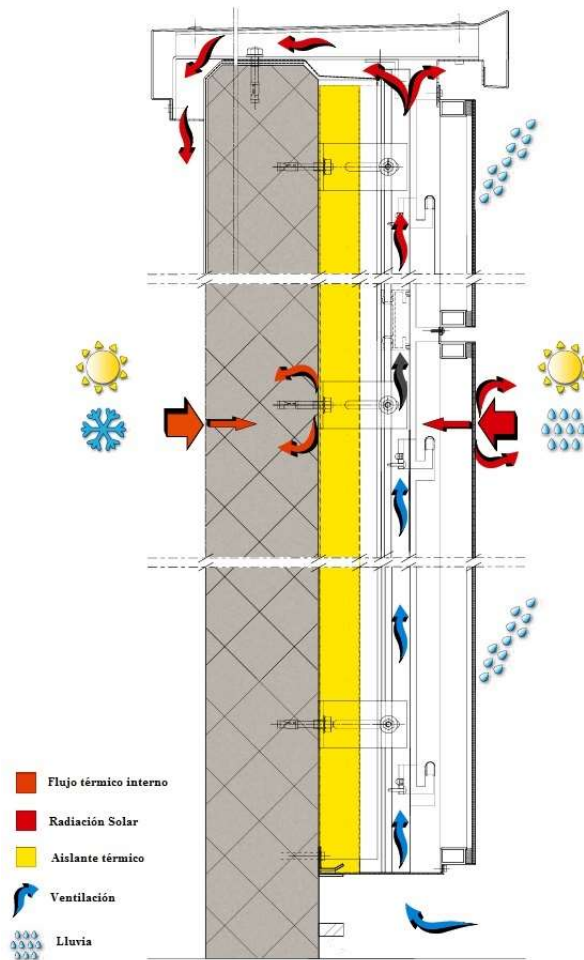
Funcionamiento de una fachada ventilada, (Fuente: LaminaM)
